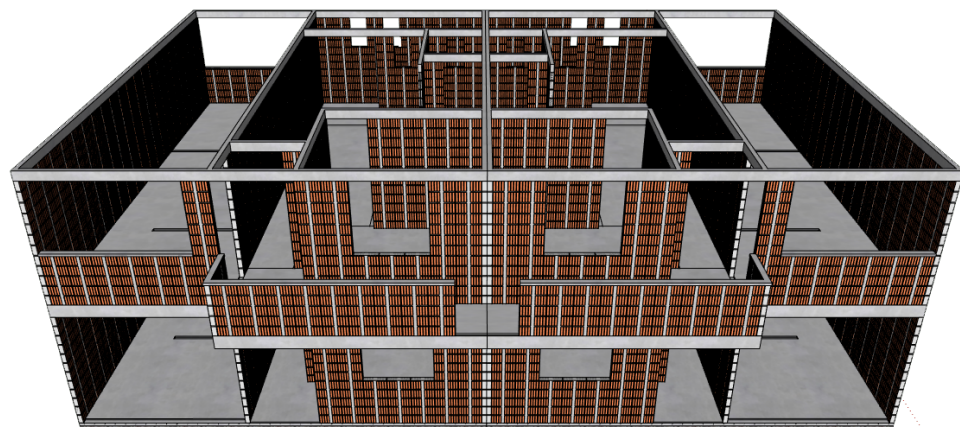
Concretagem da laje superior com sucos na superfície para auxiliar no posicionamento e estabilização dos painéis
